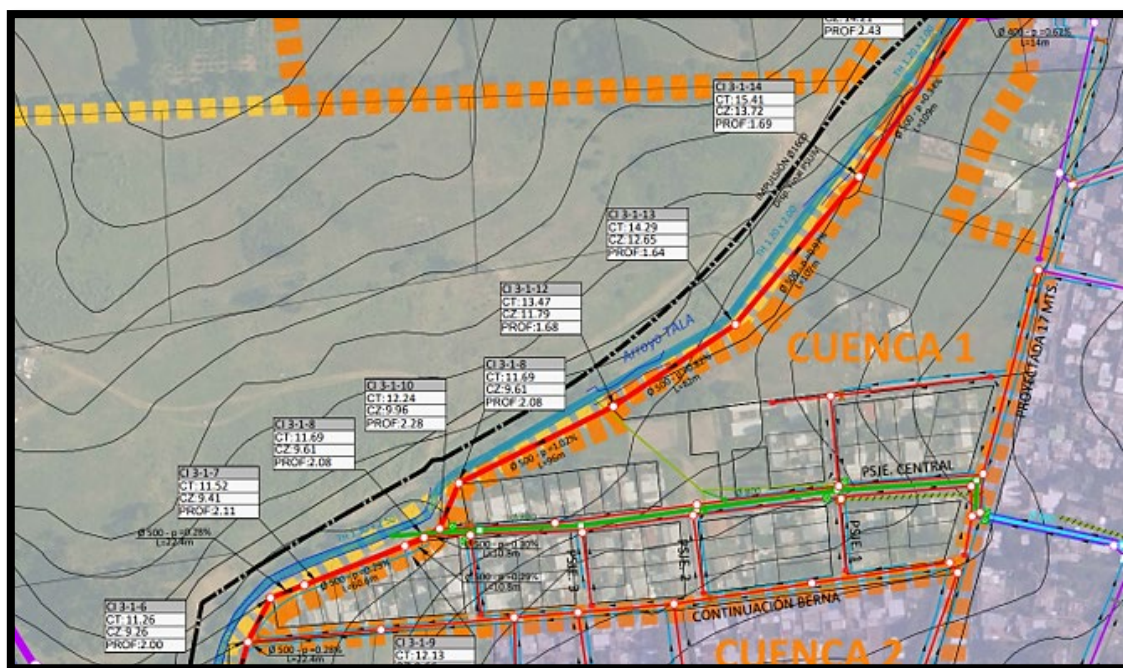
Planimetría saneamiento proyectado en línea Roja en Cuenca 1. Fuente Intendencia de Montevideo
